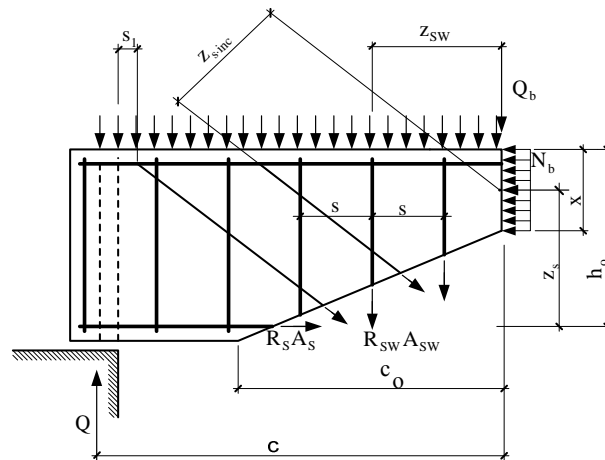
Розрахункова схема зусиль у похилому перерізі.
